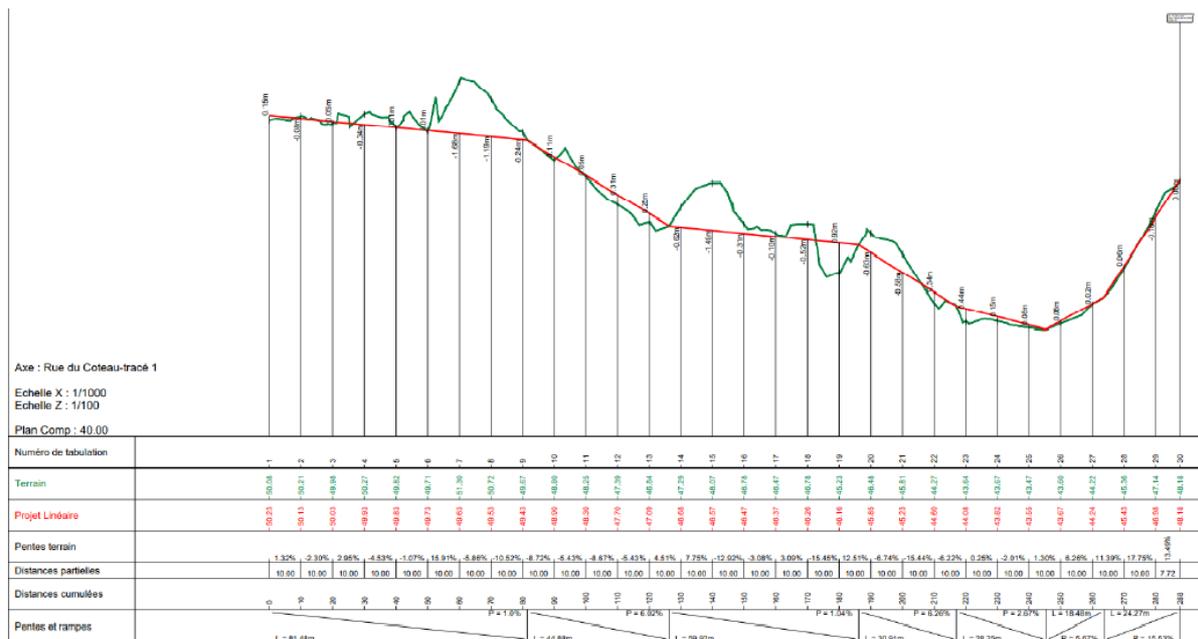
Profil en long de la rue des coteaux -secteur 2
